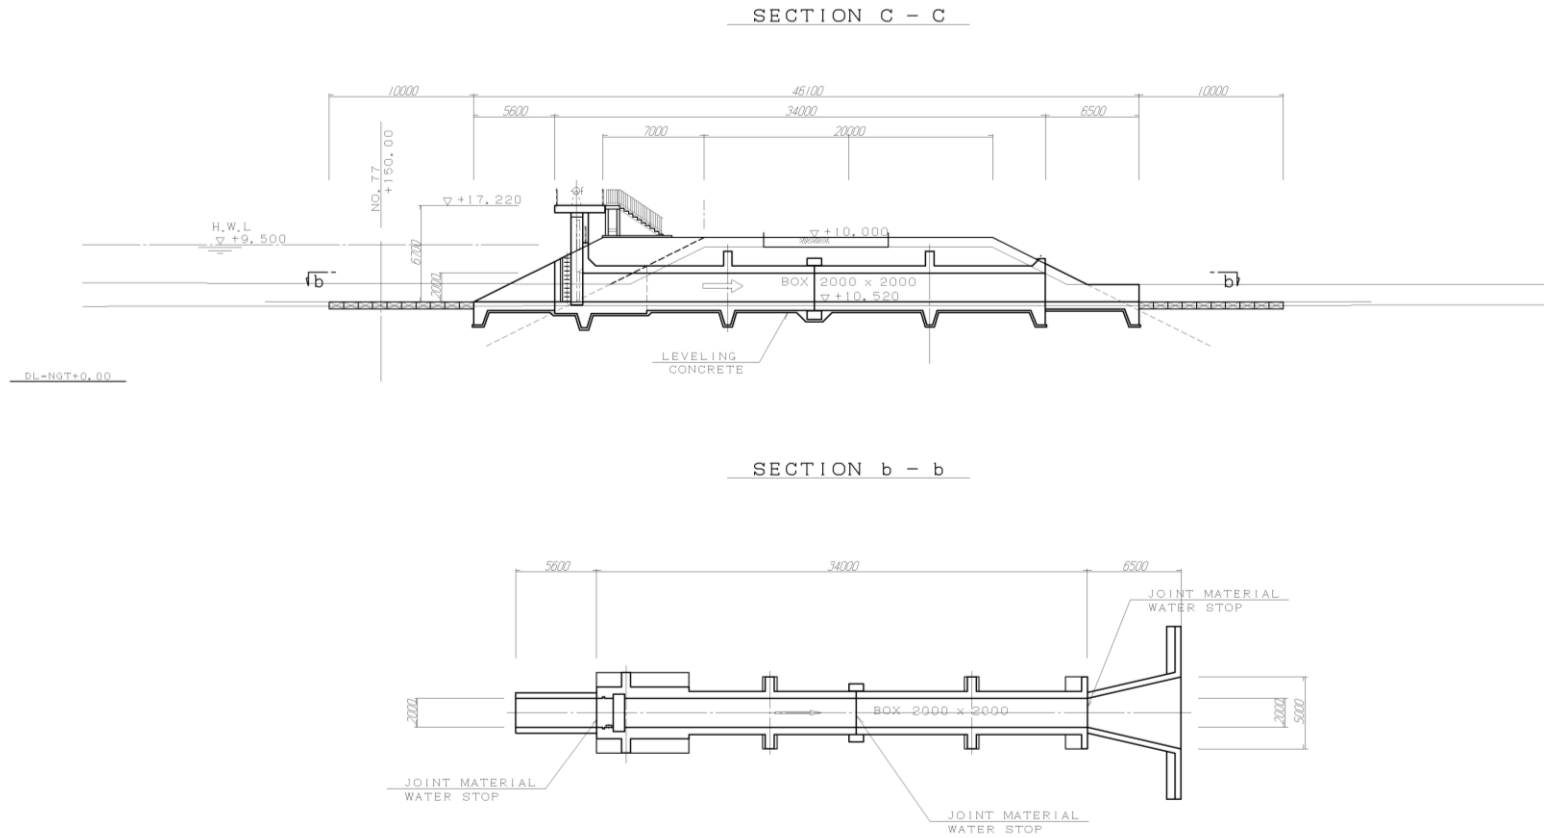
流量調節施設一般図(2) 内側水路ゲート
